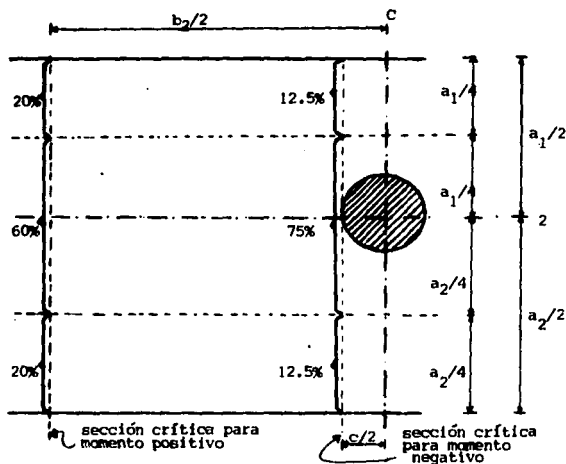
Distribución de momentos flexionantes en franja de columnas y franja central.
